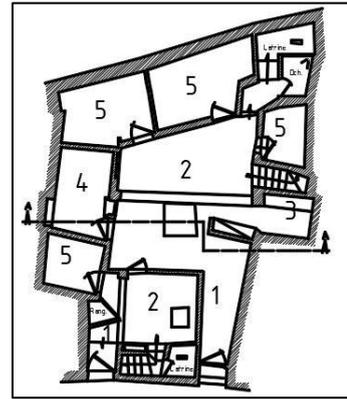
plan RDC d'habitat traditionnel. Source : plan modifié par l'auteur
